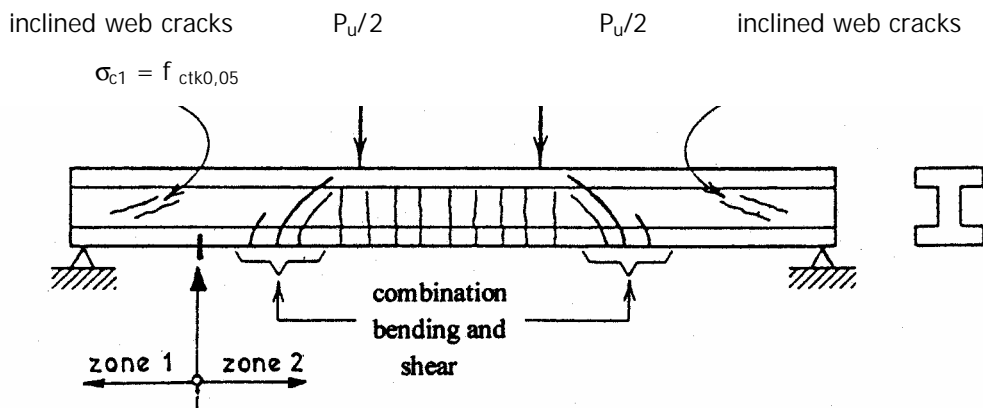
Zonas fissuradas e configuração no elemento de concreto armado ou protendido.
